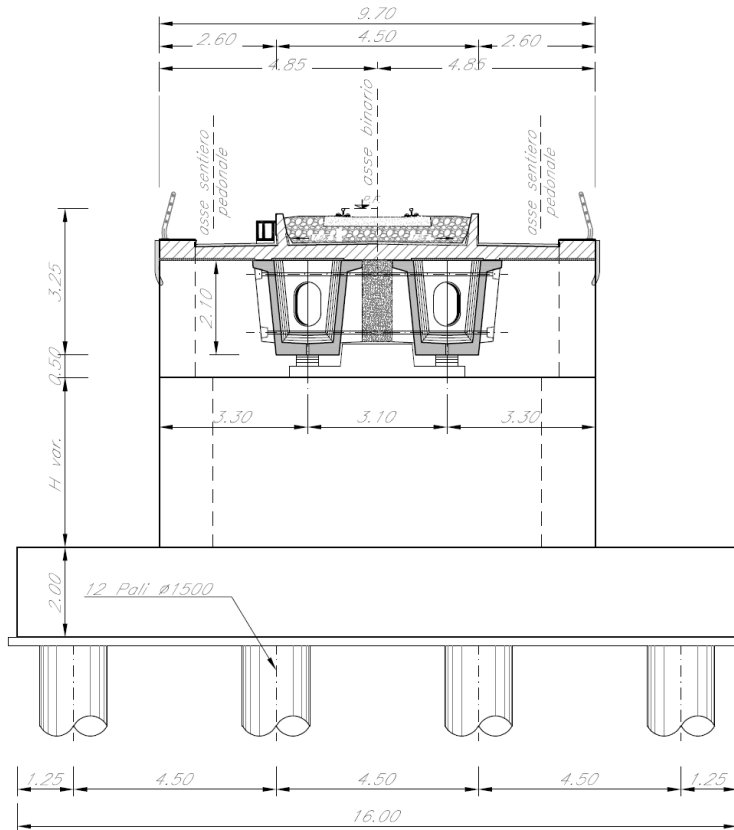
Sezione trasversale spalla H=6.50 m
